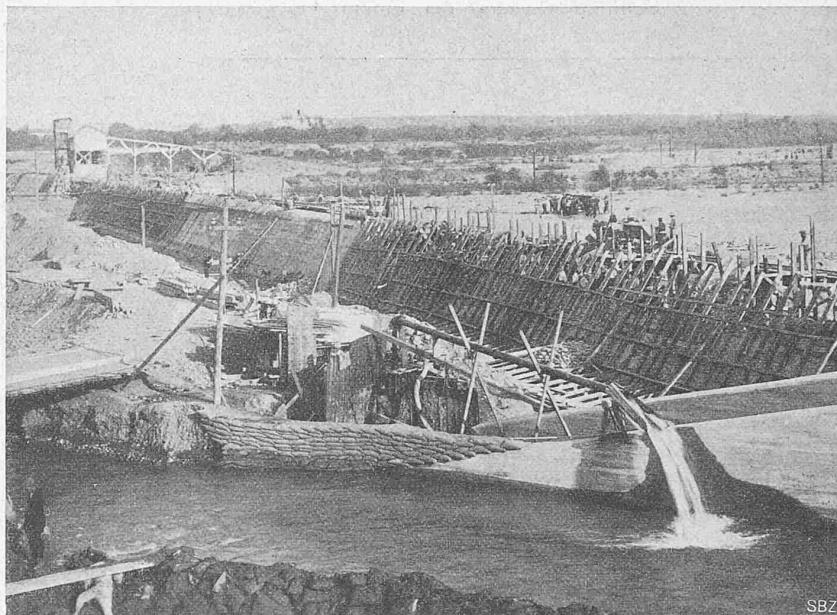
Das Stauwehr im Bau, im Vordergrund Flossgasse und Grundablass.
